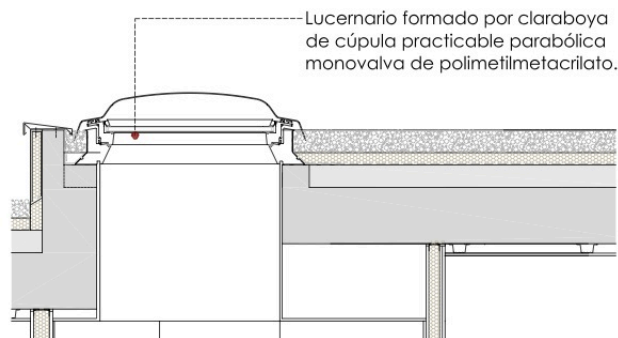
Detalle en sección del lucernario en 1ª Planta
